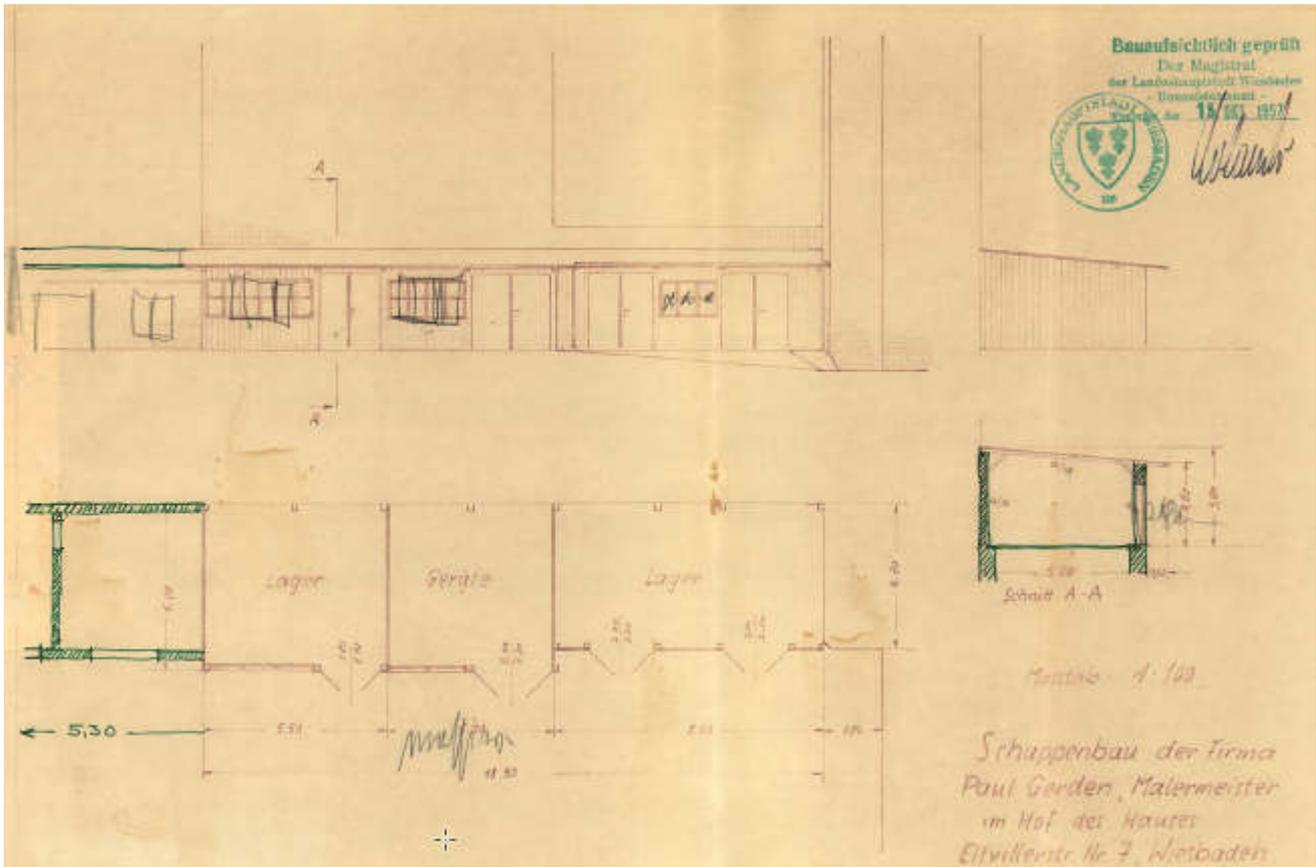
Grundriss, Ansicht und Schnitt des Lagergebäudes, Schuppens (ohne Maßstab); Quelle: Bauakte
